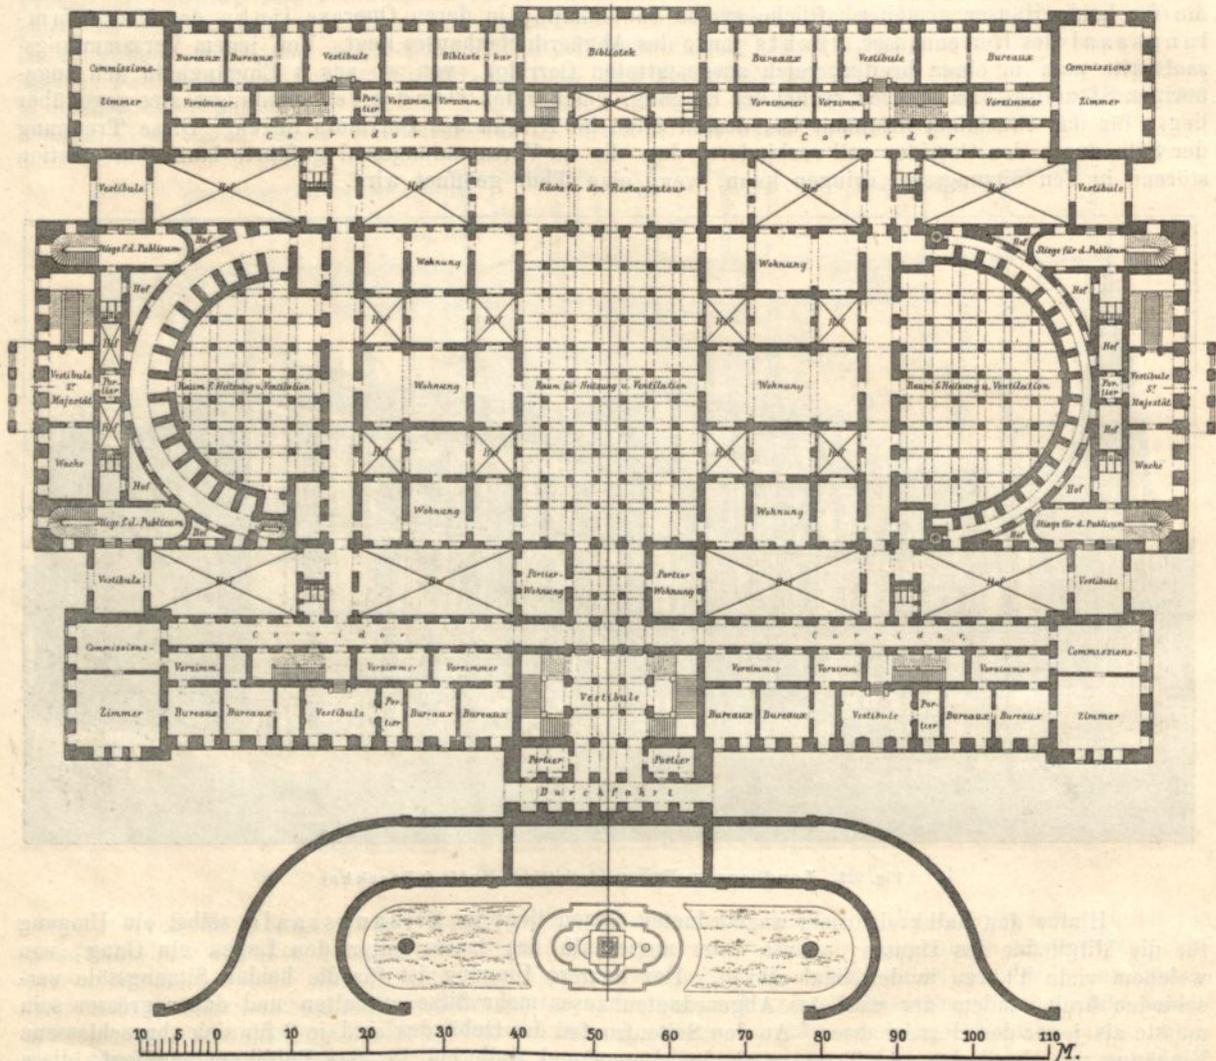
Reichsrath-Gebäude zu Wien. Erdgeschoss (Architekt Baron Hansen).
